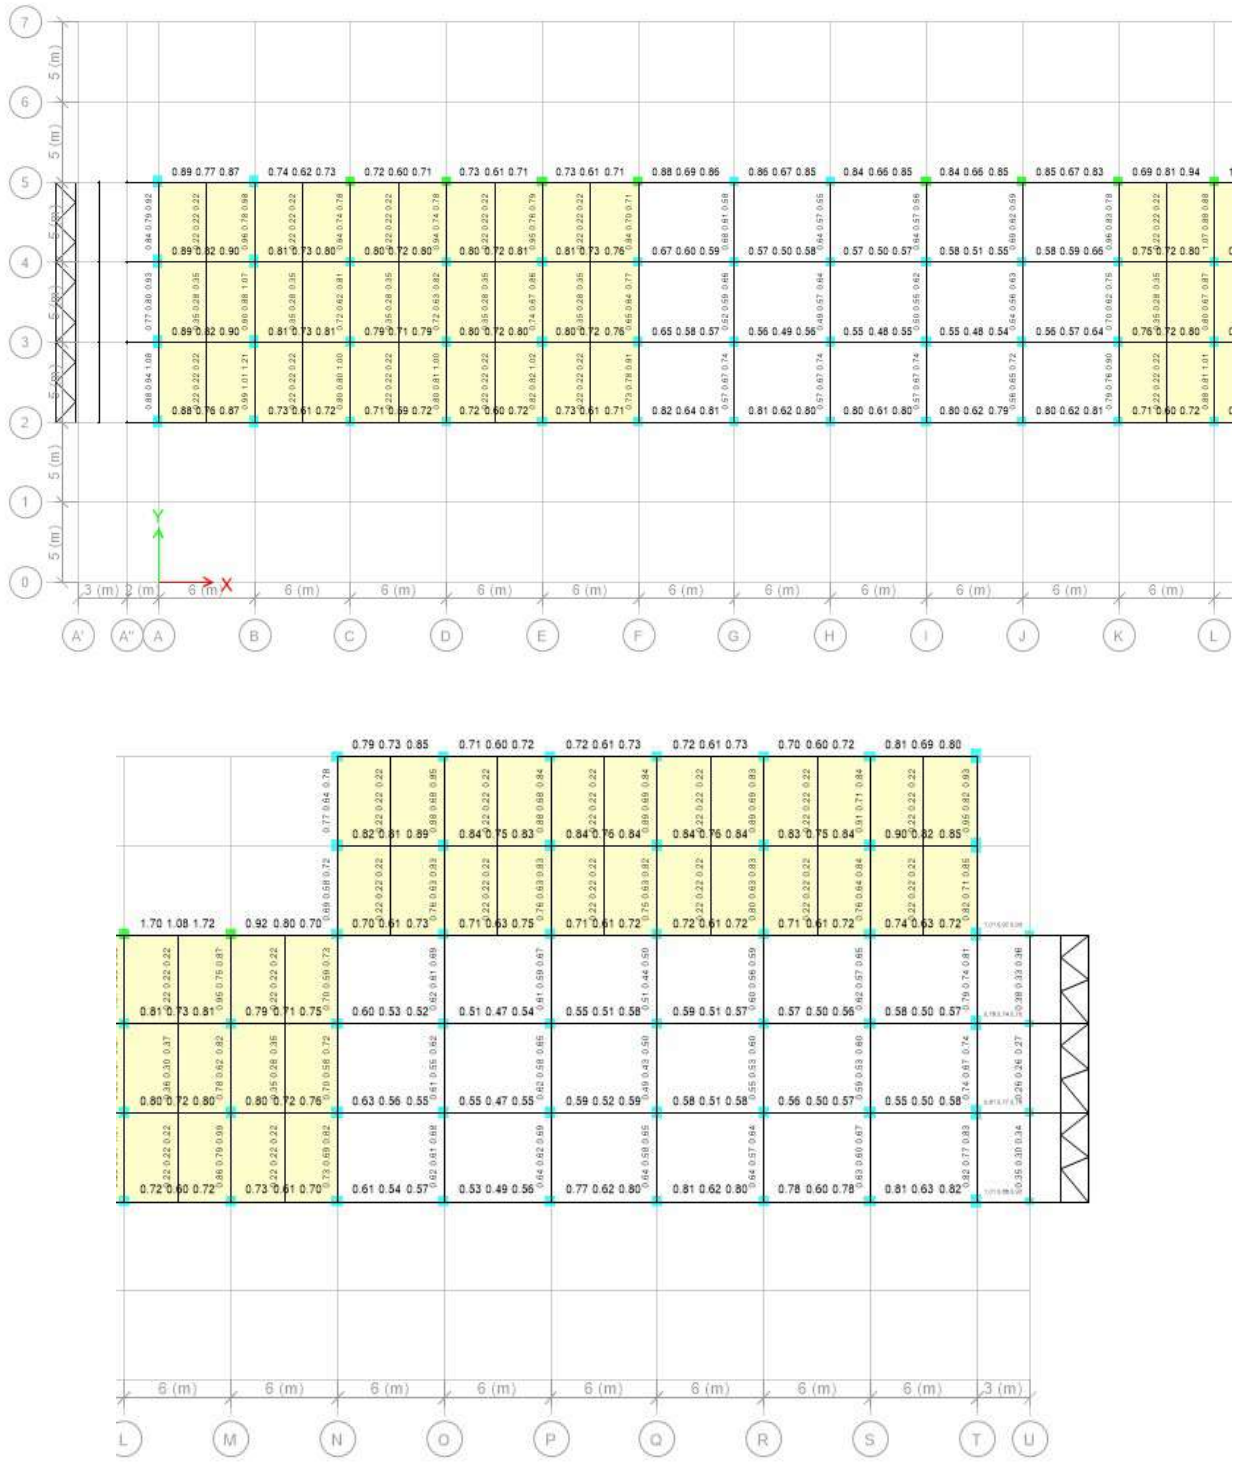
Tulangan Lentur Balok Lantai Atap
